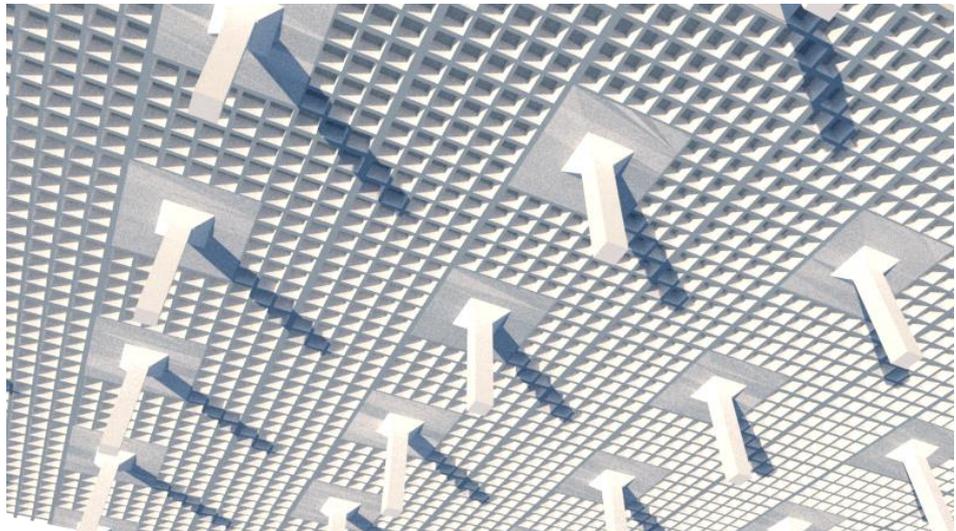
Struktur balok dan plat keseluruhan bangunan
